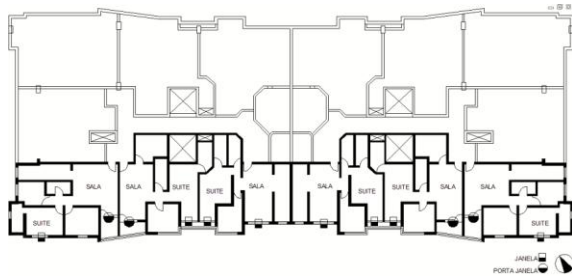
Planta baixa esquemática do Edifício 01. (elaboração própria)
